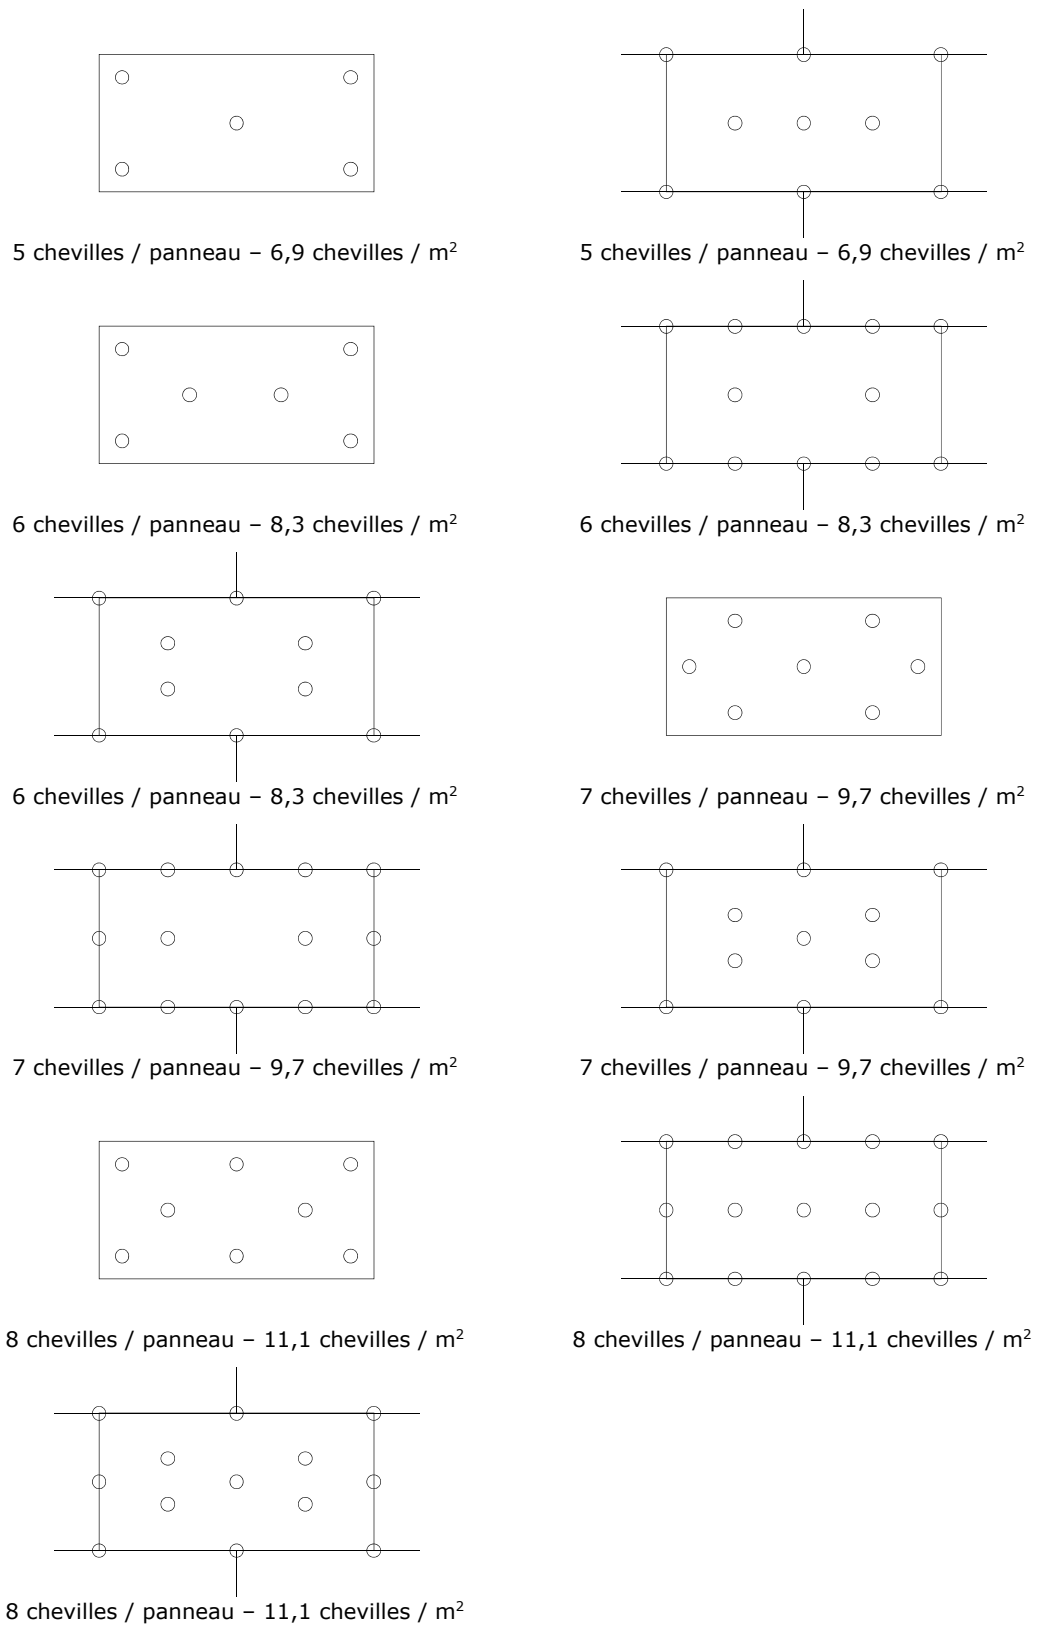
Plans de chevillage – panneaux de dimensions 1200 x 600 mm
